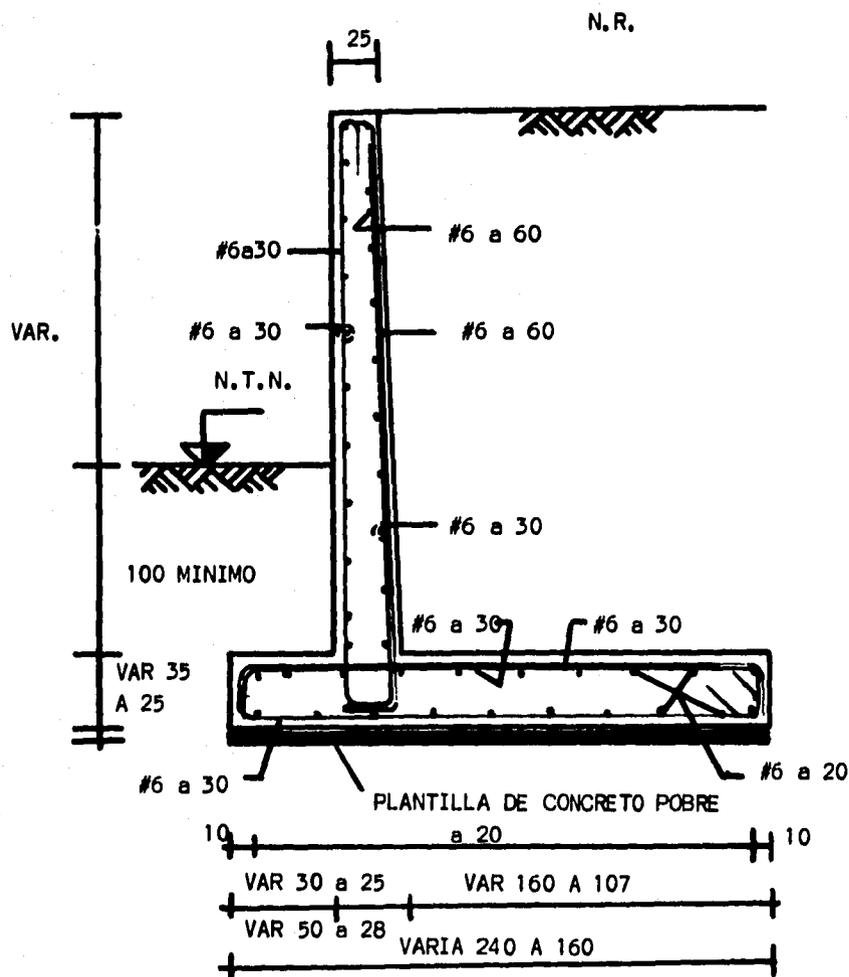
MURO DE CONTENCION TRAMO 2
